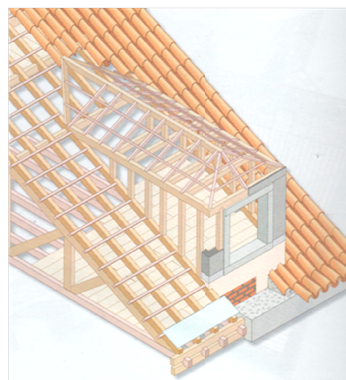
Composição do telhado em zona de trapeira (Appleton, 2003).
